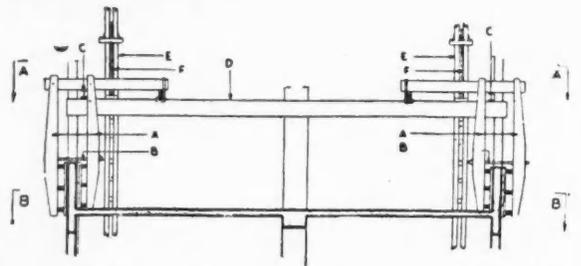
Fig. A. Coupe transversale sur un étage d'immeuble en construction, montrant la disposition des coffrages montants.
